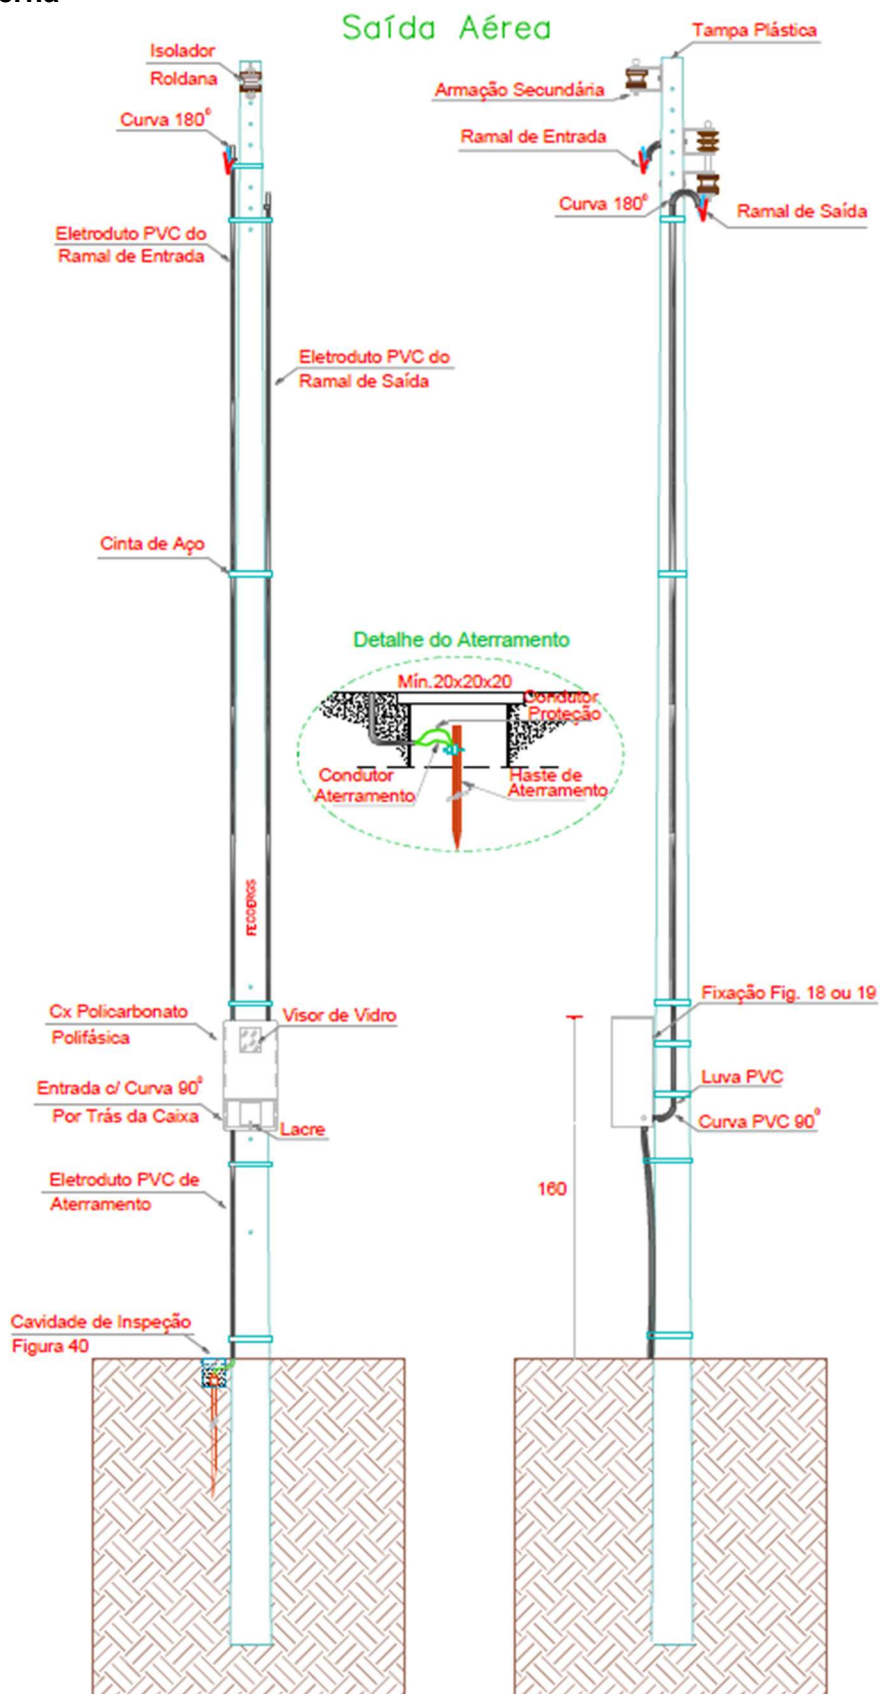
(D) – Poste Particular de Concreto Armado com Caixa de Medição Acoplada
